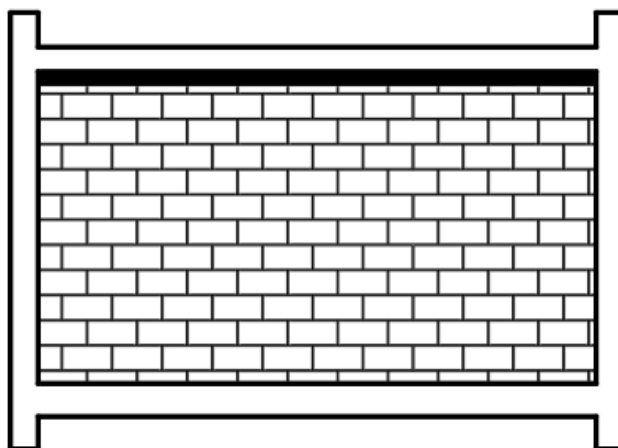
Encunhamento entre alvenaria e viga executado espuma expansiva.
